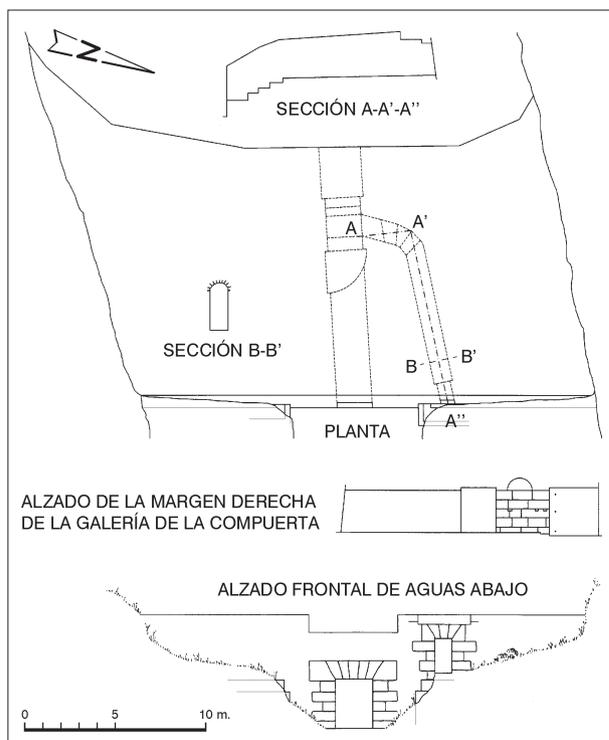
La presa de Bernayán: Planta, alzado, sección longitudinal de la galería de la compuerta y secciones longitudinal y transversal del pasadizo de acceso al mecanismo de la compuerta.
